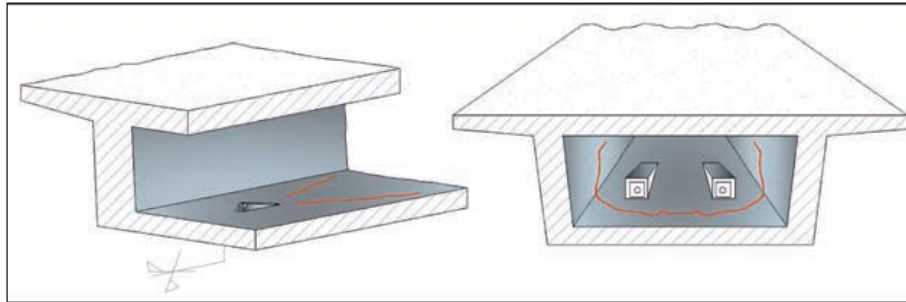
FISURAS EN ZONAS DE ANCLAJES INTERMEDIOS, DEBIDAS A LA CONCENTRACIÓN DE TENSIONES INTRODUCIDAS POR EL ANCLAJE INTERMEDIO Y NO TRANSFERIDA A LA ZONA POSTERIOR.
